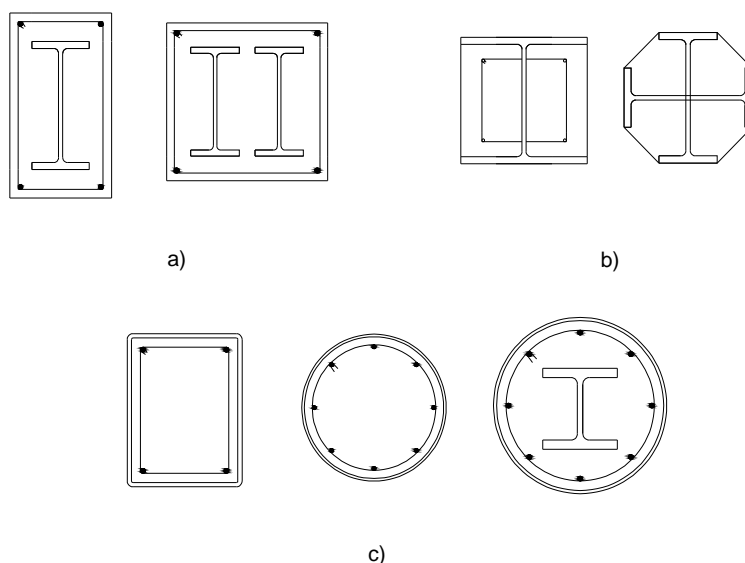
Exemplos de pilares: a) completamente envolvidos em betão; b) parcialmente envolvidos em betão; c) preenchidos por betão
